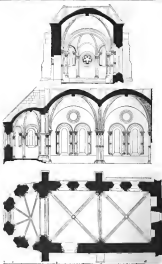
Grundriss, Längs- und Querschnitt der Klosterkirche (nach Leitzke)
